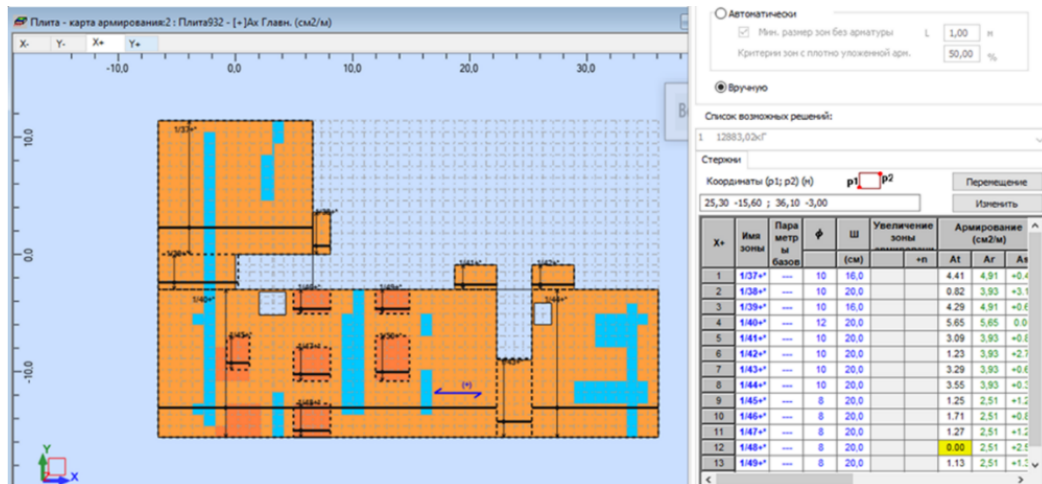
Верхнее армирование плиты по оси X в ПК RSA
